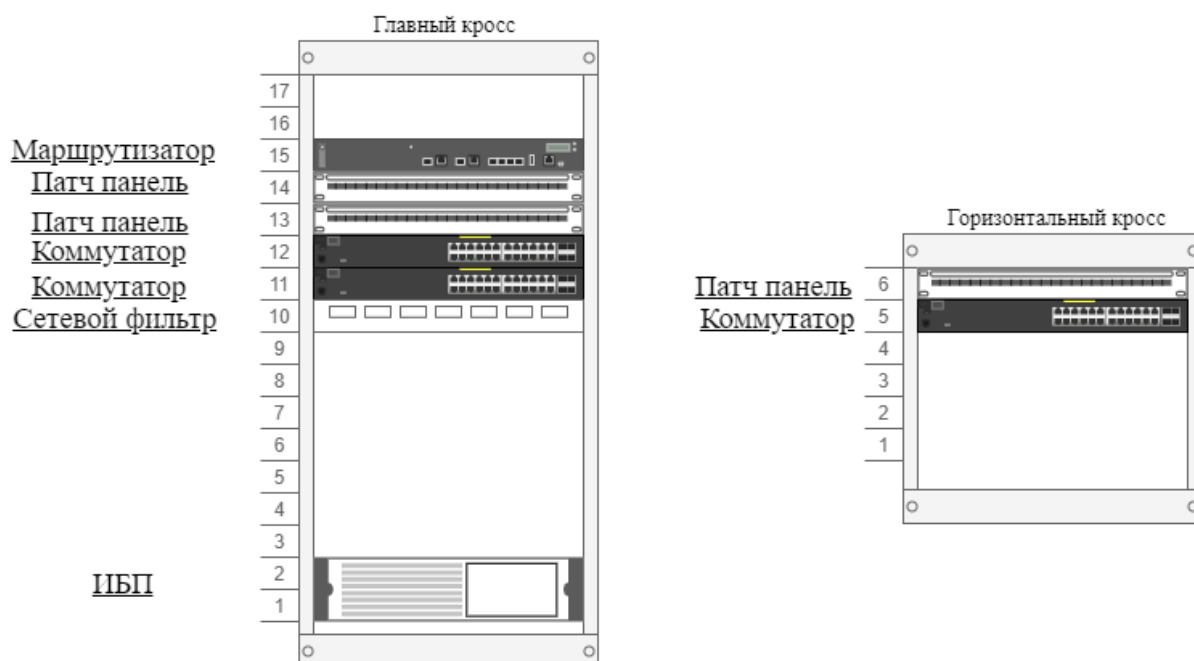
Схема установки оборудования, здание Лицей
